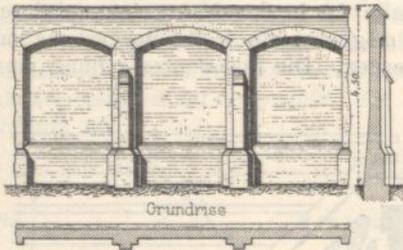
Ansicht, Querschnitt und Grundriss einer Ringmauer.
